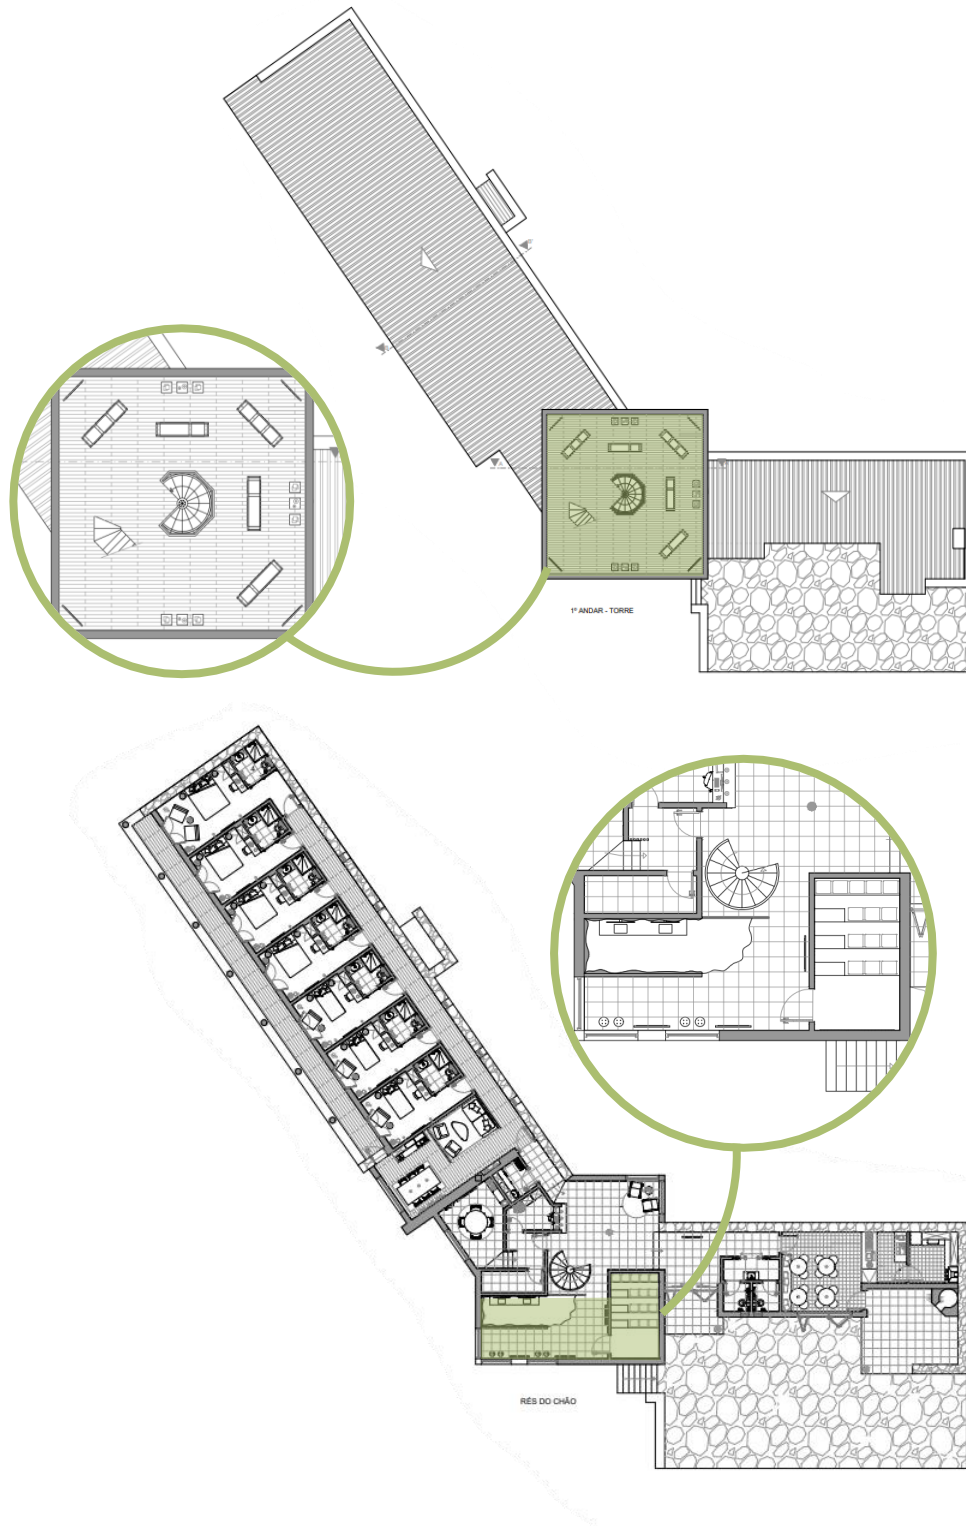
Planta de Apresentação com detalhes das zonas de exposição. Fonte: Autor.
